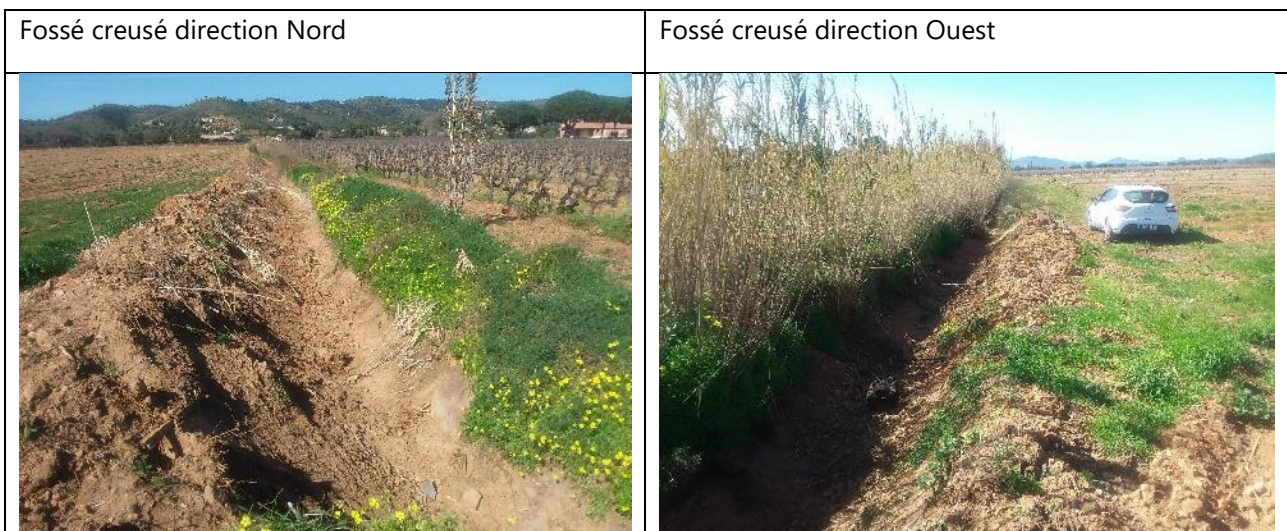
ZONES D'EXCAVATION DEFOSSÉ PLUVIAL
